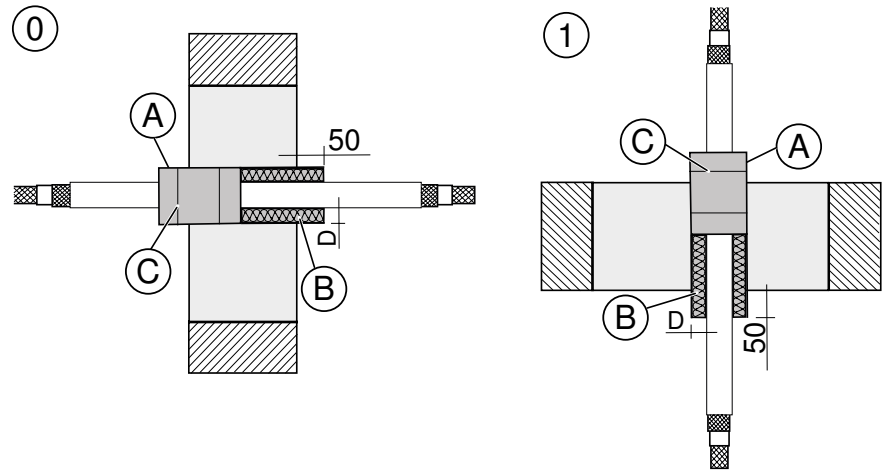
Hydraulikschläuche "HANSA-FLEX" in Wand ① und Decke ② mit Streckenisolierung und Brandschutzwickel
